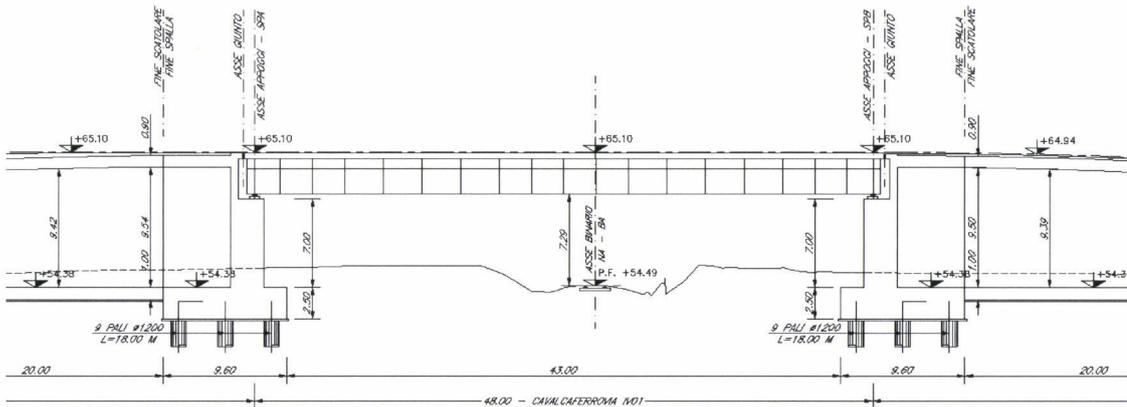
Campata di scavalco a sezione mista - Prospetto.
